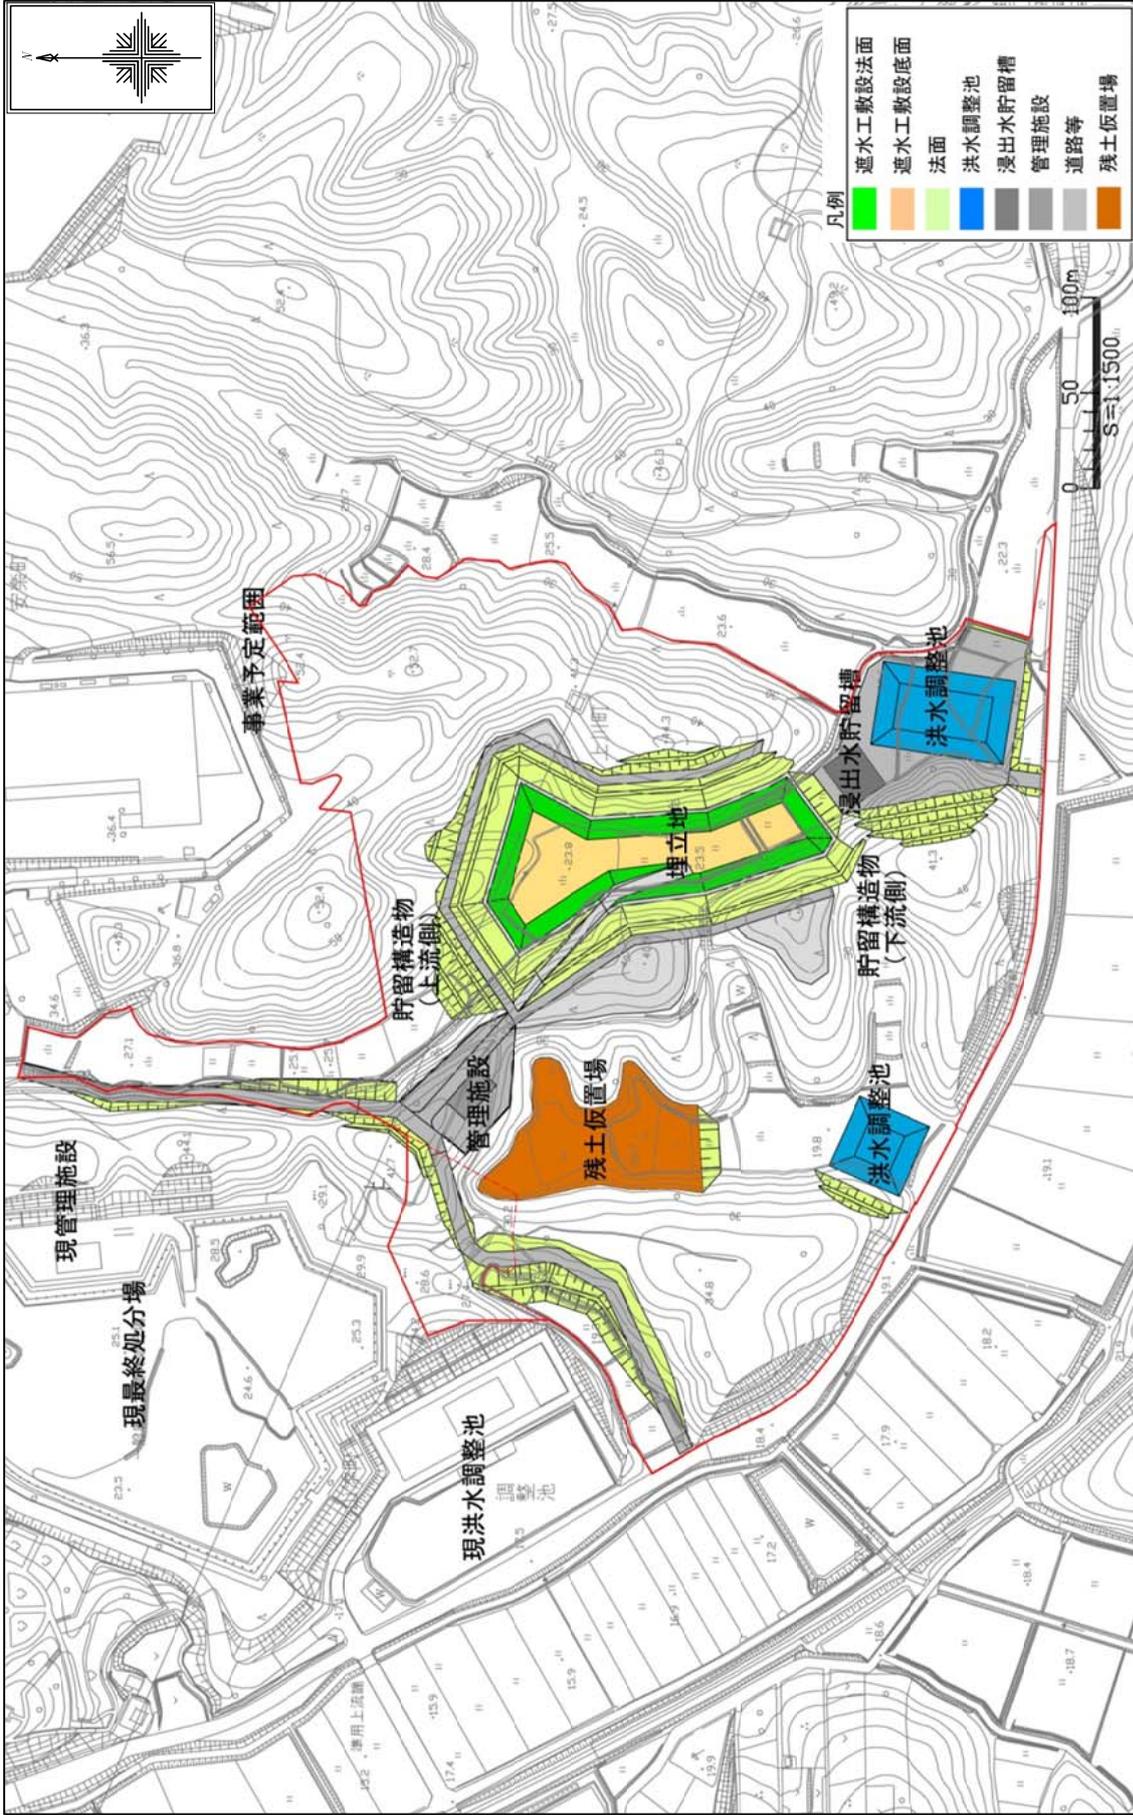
新最終処分場配置平面图 (第 1 期)
